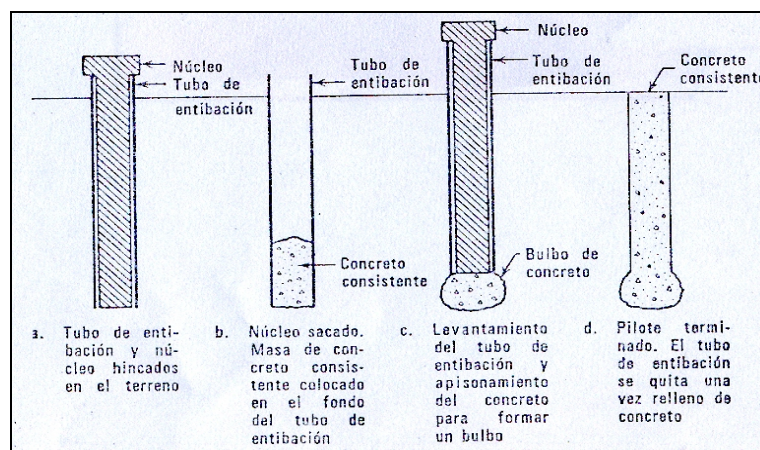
Construcción de un pilote de bulbo sin tubo de entibación
